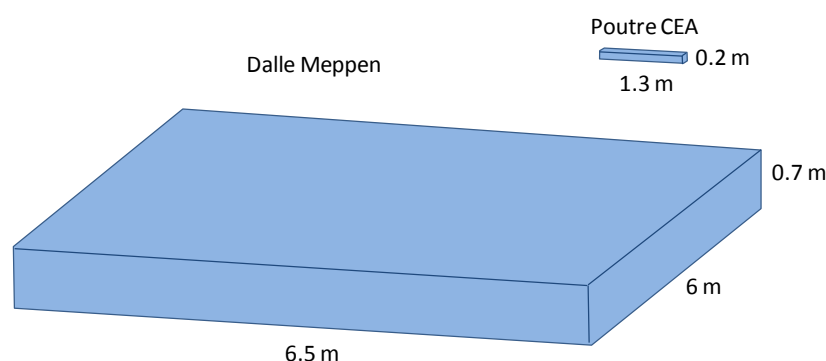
Comparaison des dimensions de la poutre CEA et de la dalle Meppen.
